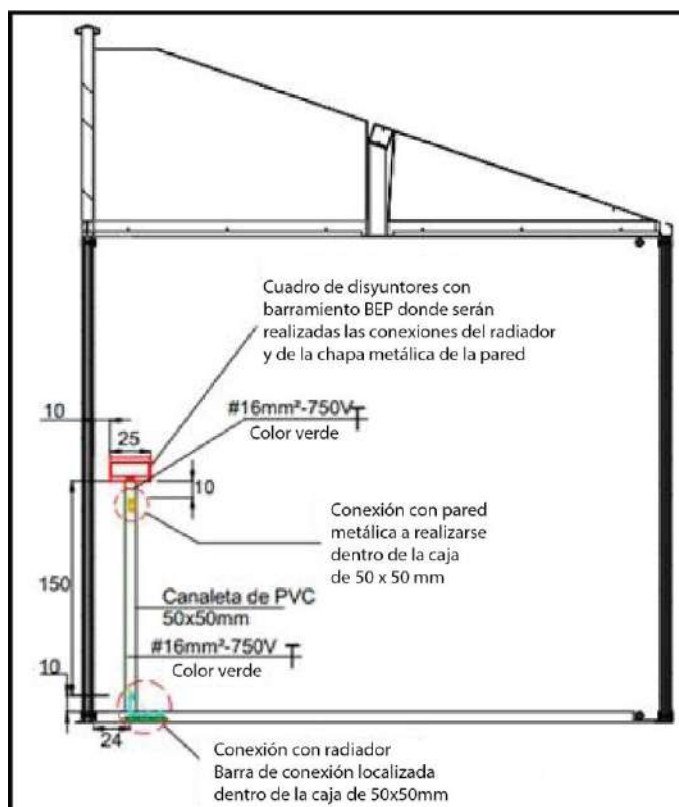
Conexión Bus BEP x Platea x Chapa Metálica del Panel
